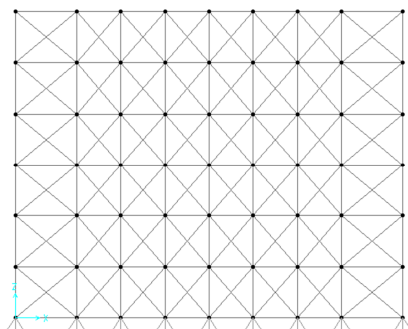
Configuração dos Planos de Contraventamento Vertical Com Elementos de Contraventamento Pequenos
